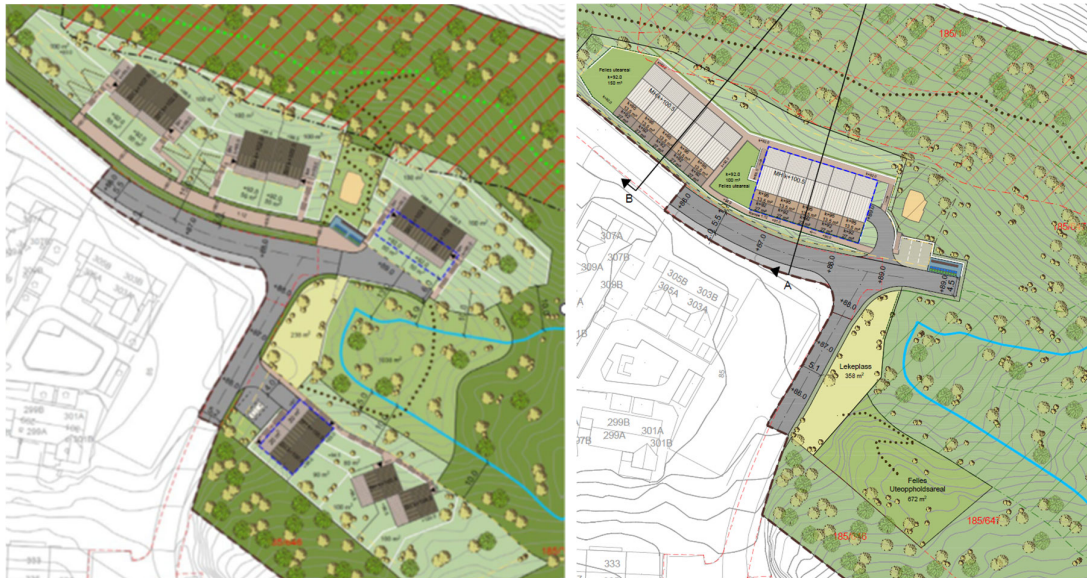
To tidligere forslag til plankart: forslag til offentlig ettersyn til venstre. Revidert planforslag levert til andregangsbehandling i 2022 til høyre.
